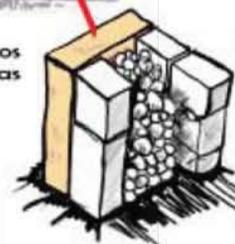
Detalle de una jamba actuando como cerramiento en el encofrado de un muro.
